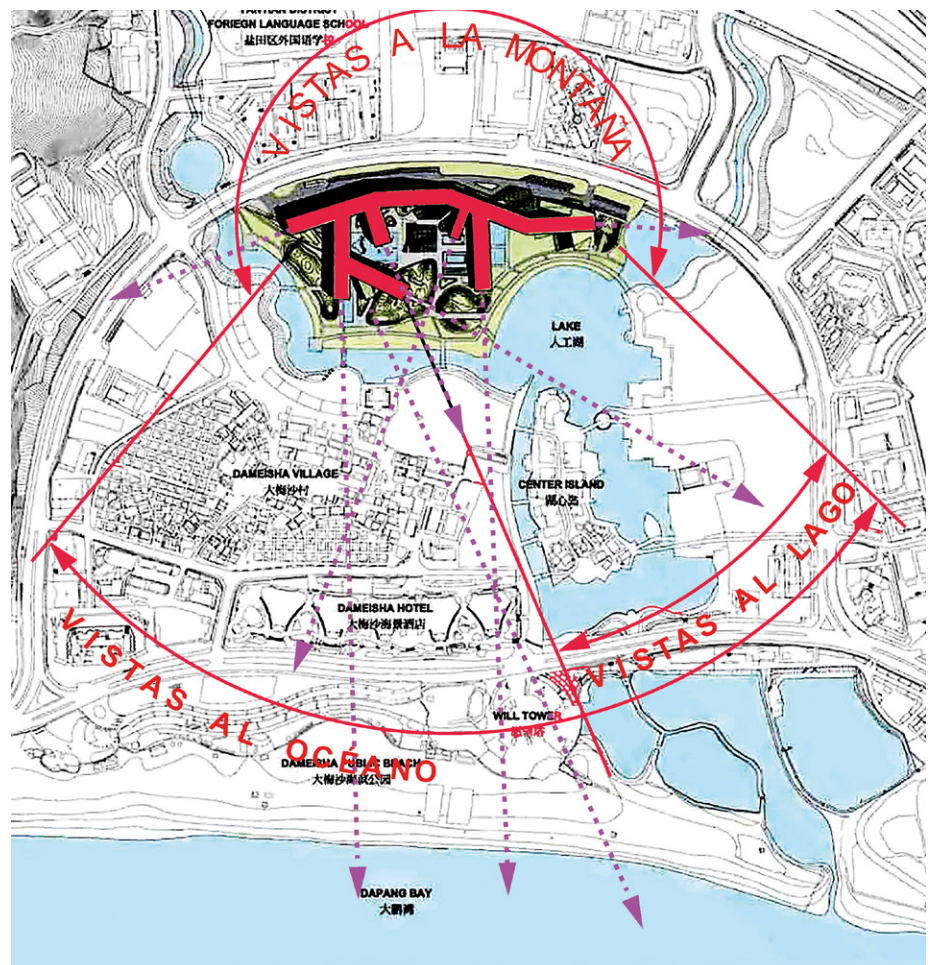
Planta de conjunto del *Horizontal Skyscraper*. Fuente: <https://acortar.link/N9LP9J>.
